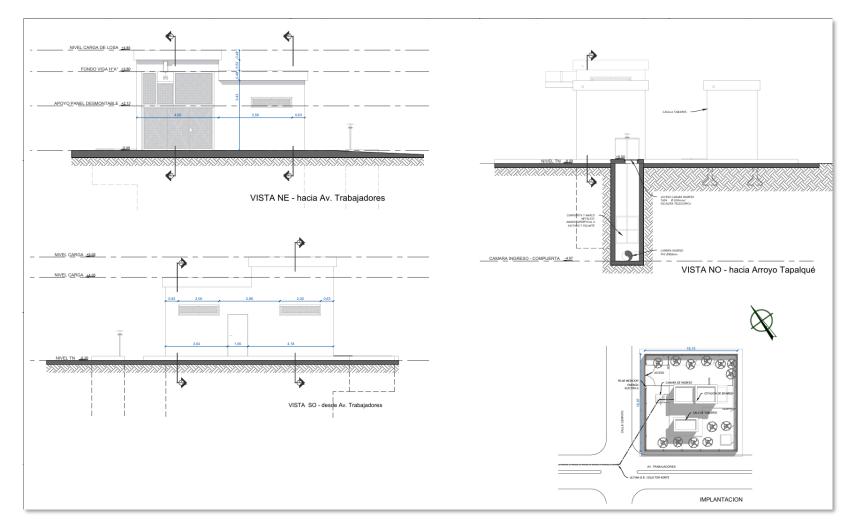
Plano con diferentes vistas de la implantación de la Estación de Bombeo.
